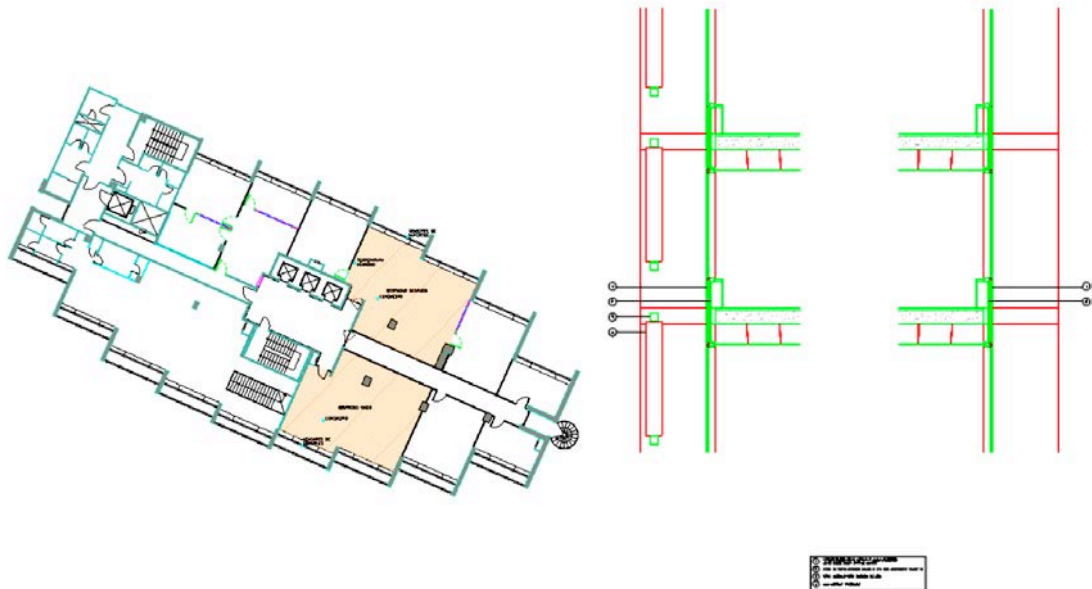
Modelos CAD de planta tipo y sección de solución de fachada para BP. Fuente: ALIA y Elaboración propia.
